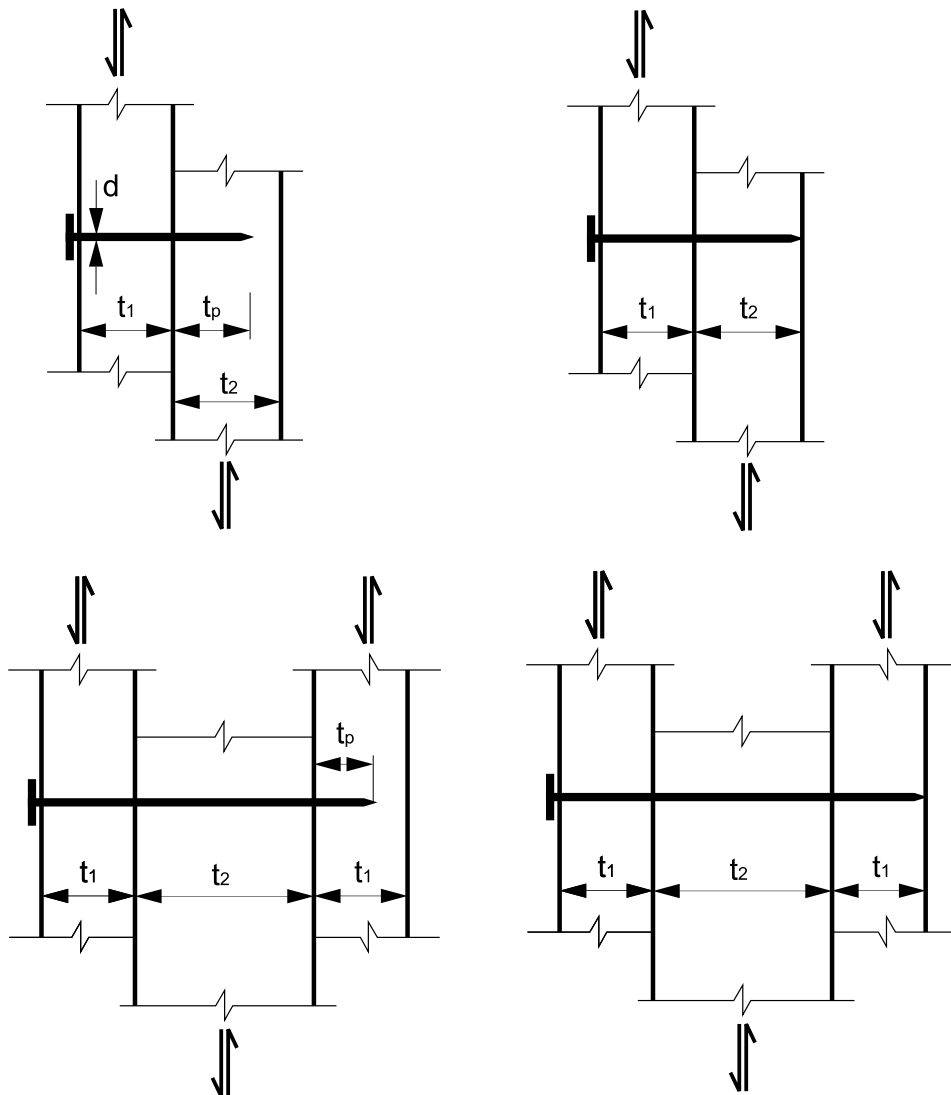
Ligações de elementos de madeira com pregos em (a) corte simples e (b) corte duplo
